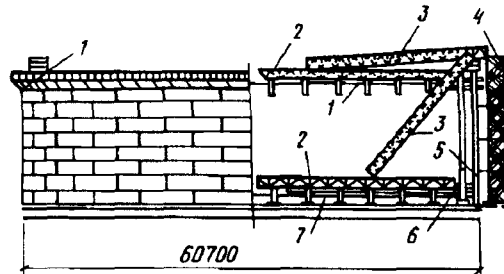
Вертикальный цилиндрический резервуар объемом 50 тыс. м³ с плавающей крышей
